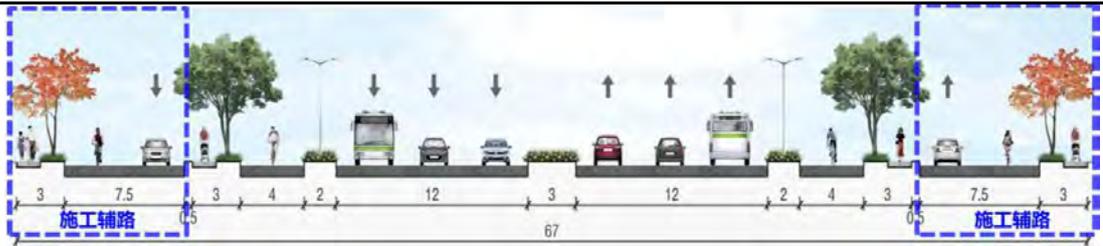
烟花三月路~头道桥第一阶段施工断面示意图
